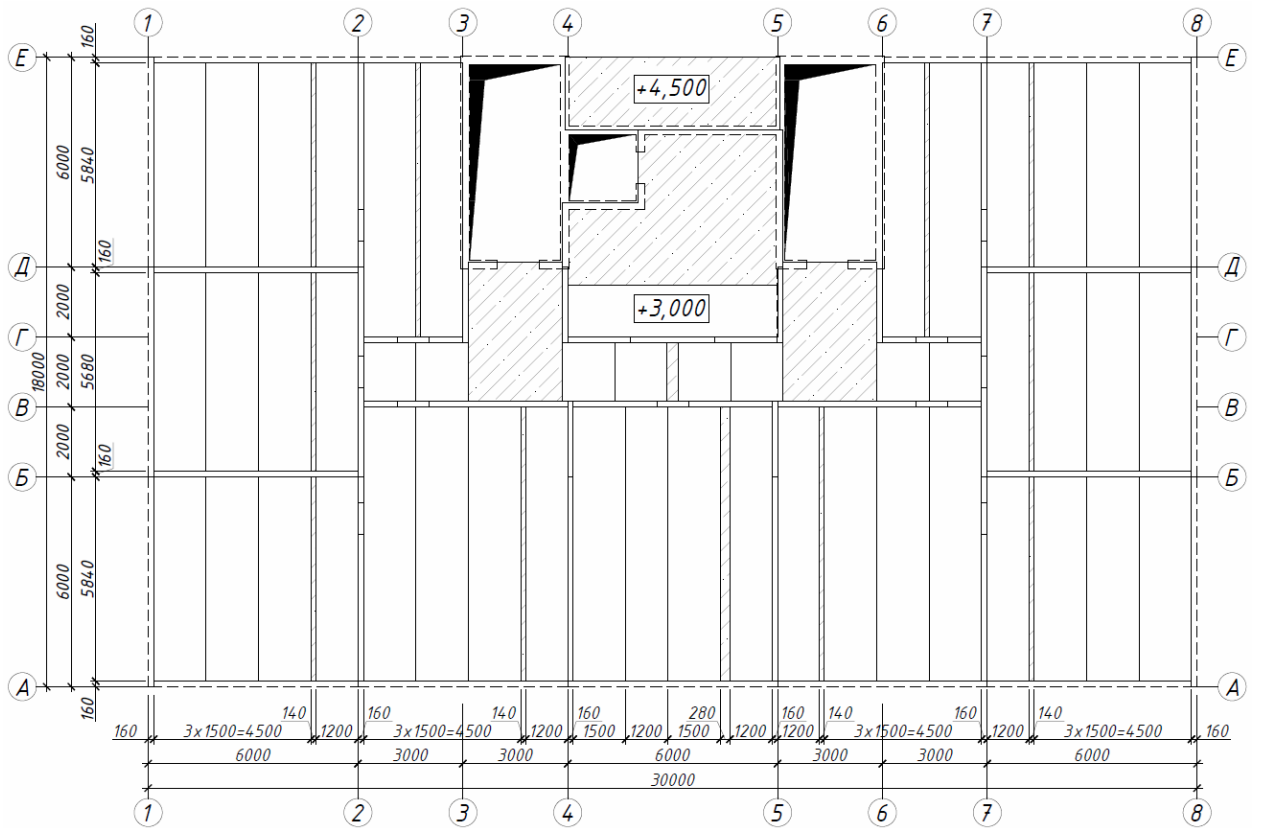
Схема перекриття із несучими стінами по буквених осях
